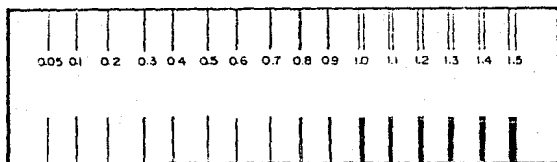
Grietómetro para medir anchos de grietas.
